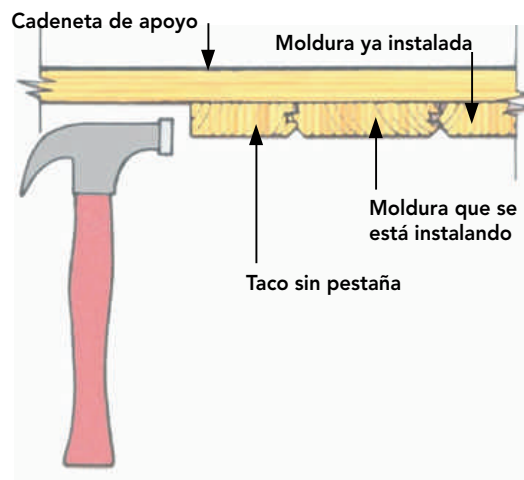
32: Corte de tabique donde se muestra taco que ayuda a asegurar el calce entre las molduras machihembradas.
